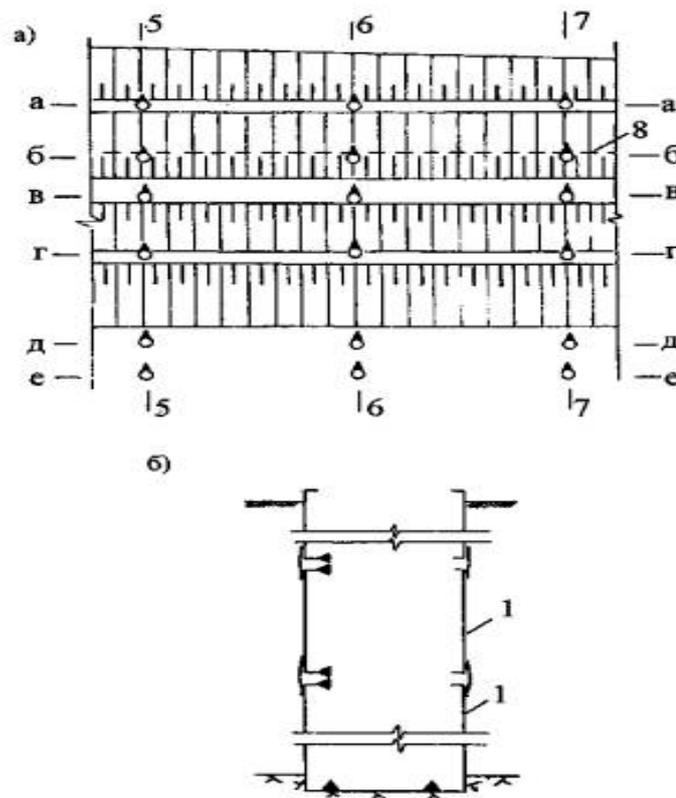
Схема размещения марок в грунтовых плотинах:
